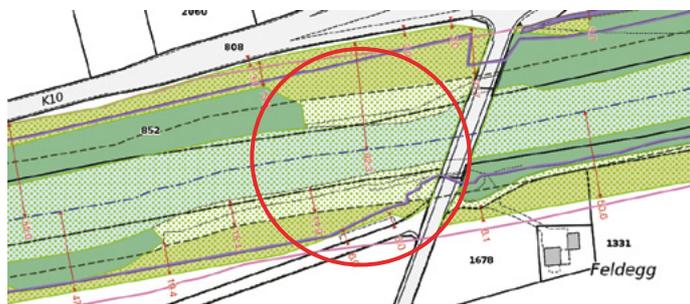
Anpassung Gewässerraum Stegmättlistrasse
